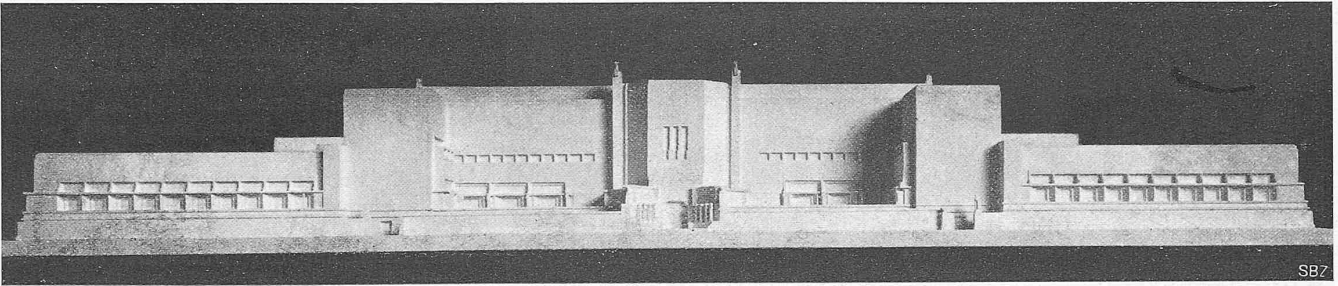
Reichsakademie für bildende Künste in Amsterdam. Entwurf 1921 der Arch. B. Bijvoet und J. Duiker. Stark monumentale Gruppierung der Massen, Steigerung der Flächenwirkung durch das Zusammenfassen der Fensteröffnungen.
